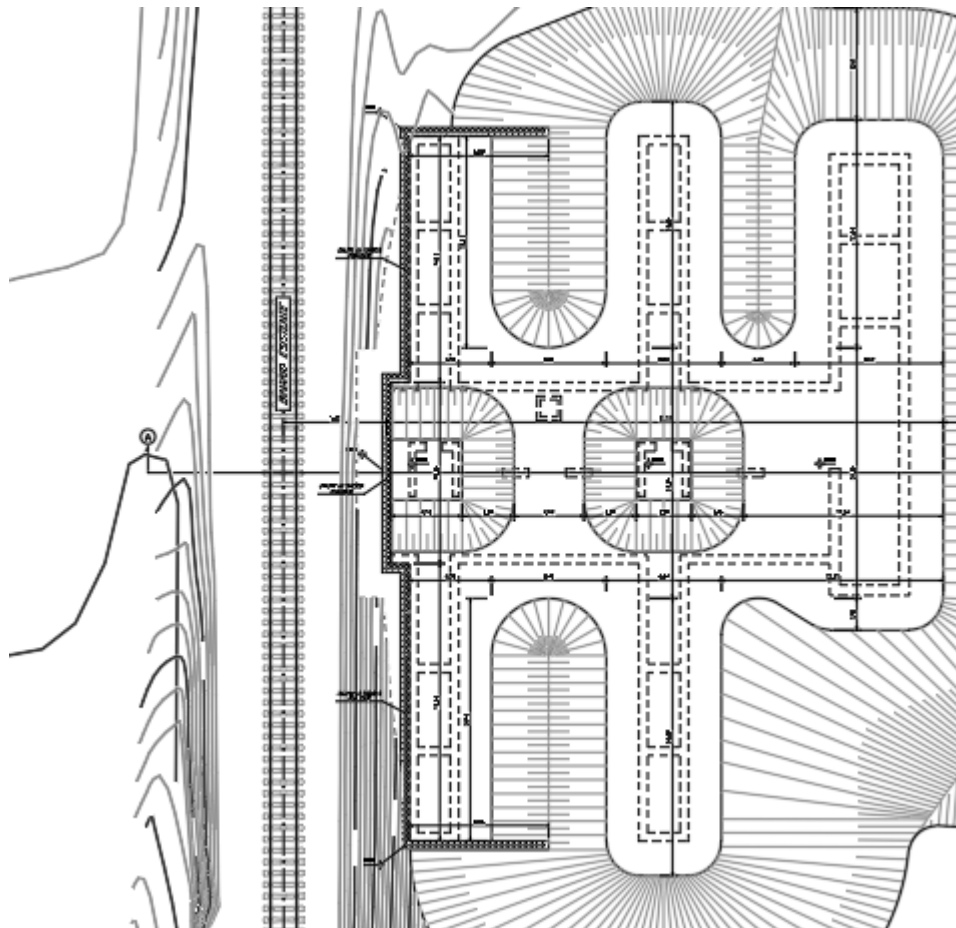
Paratia provvisoria: inquadramento planimetrico
